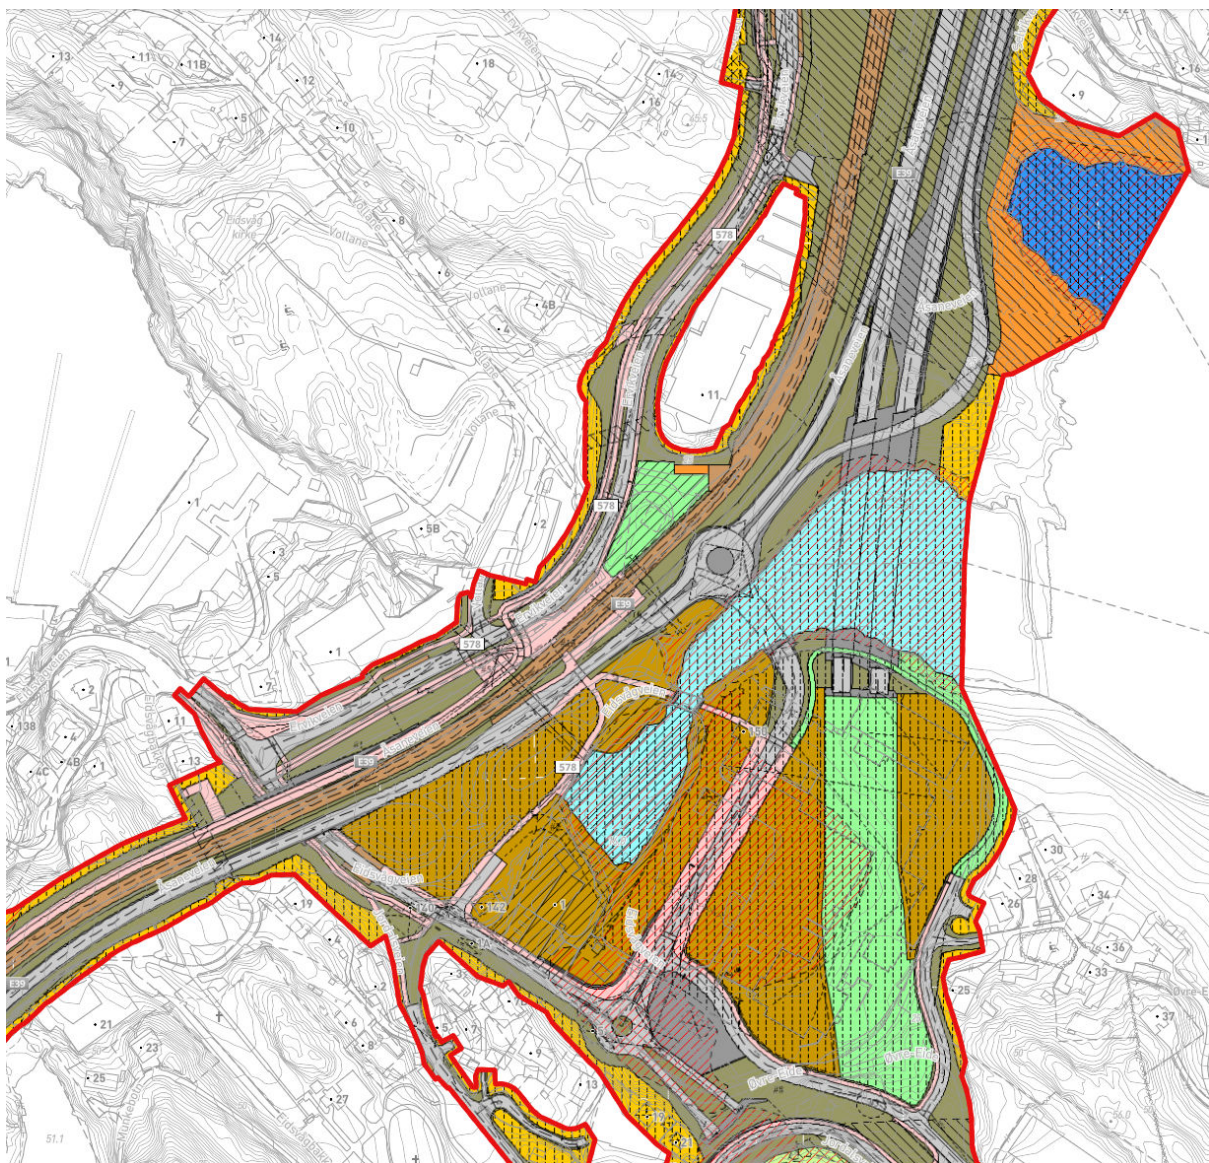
Plankartet for detaljreguleringsplan Vollane - Haugane.
